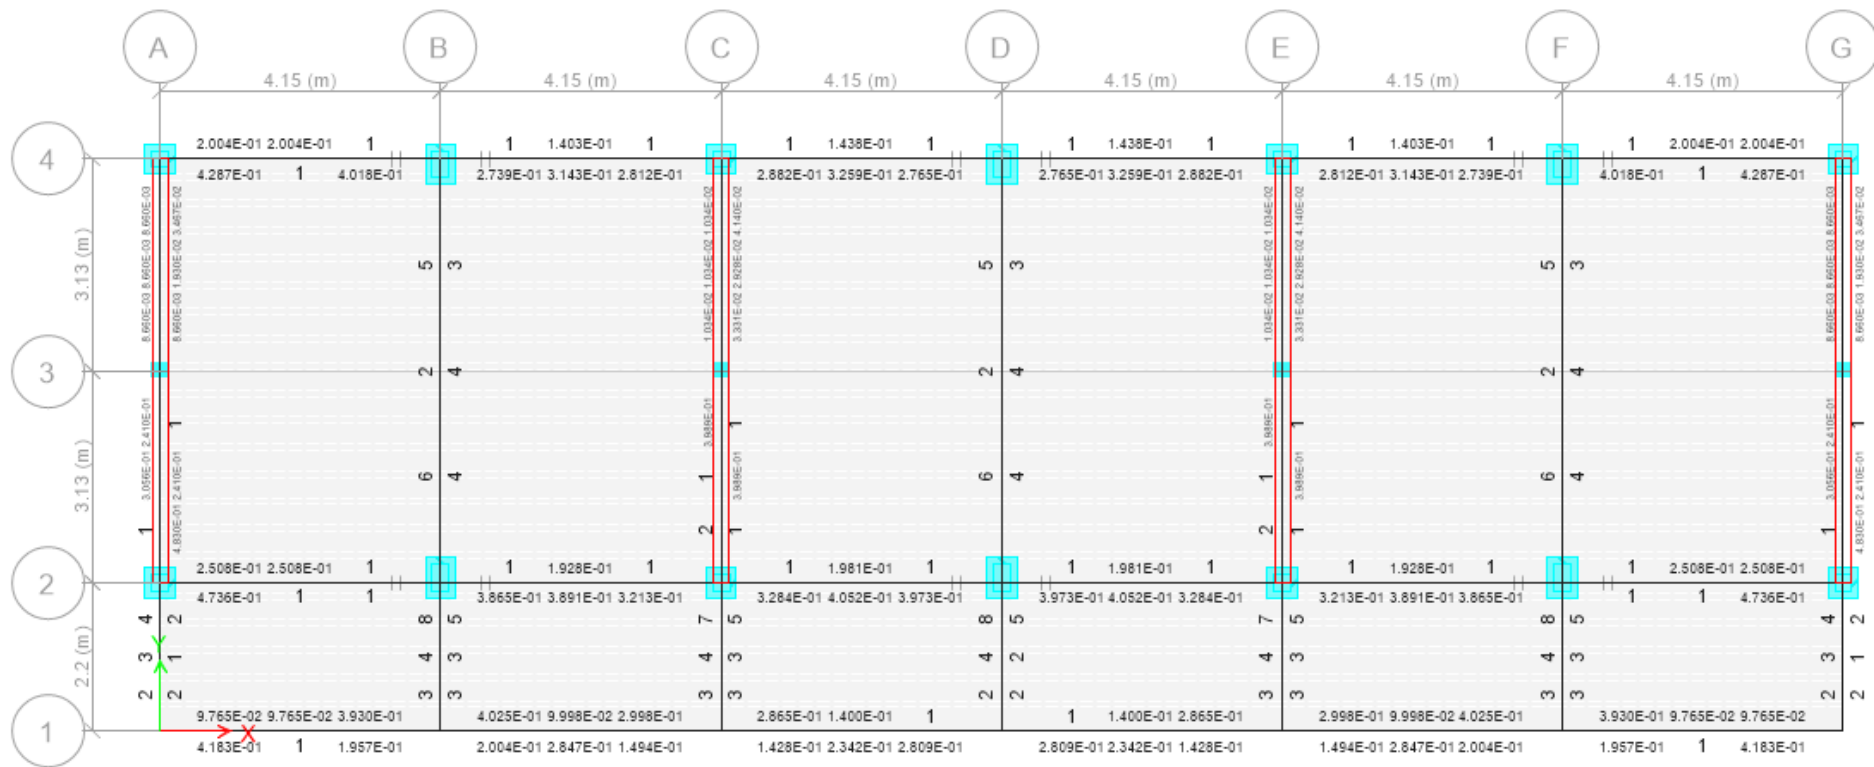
Chequeo de acero longitudinal en vigas del primer piso (el área de acero se encuentra en cm²)
